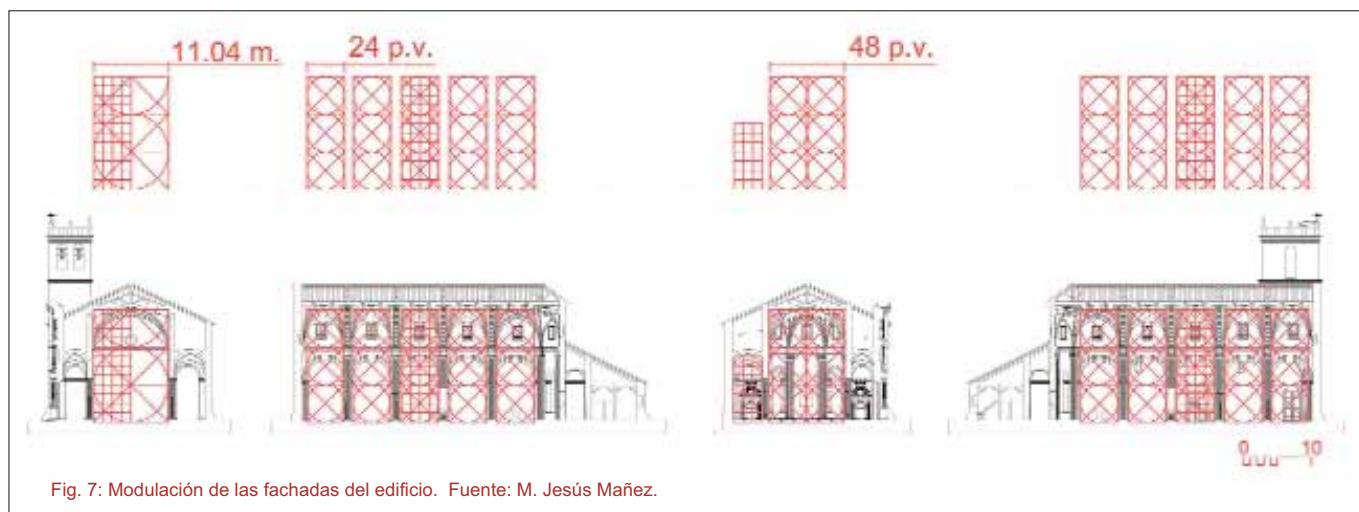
Modulación de las fachadas del edificio. Fuente: M. Jesús Mañez.
